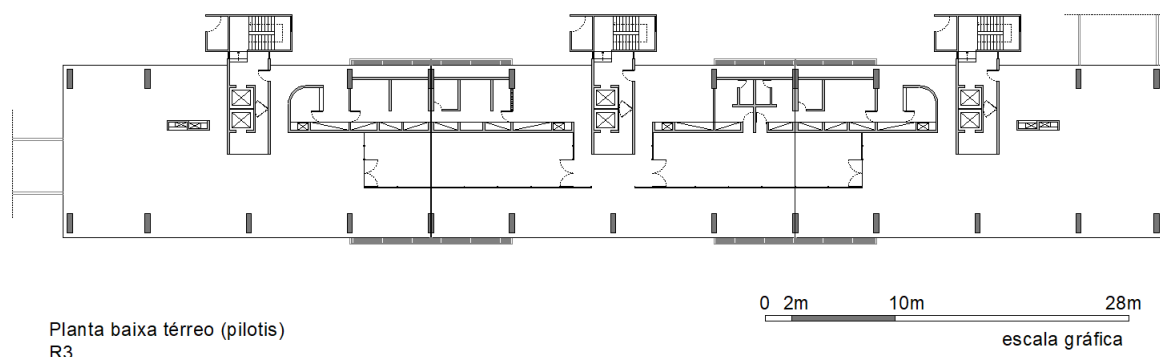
Planta baixa do térreo (pilotis) do R3. Fonte: da autora, adaptado das pranchas originais Acervo do Arquiteto Milton Ramos.
